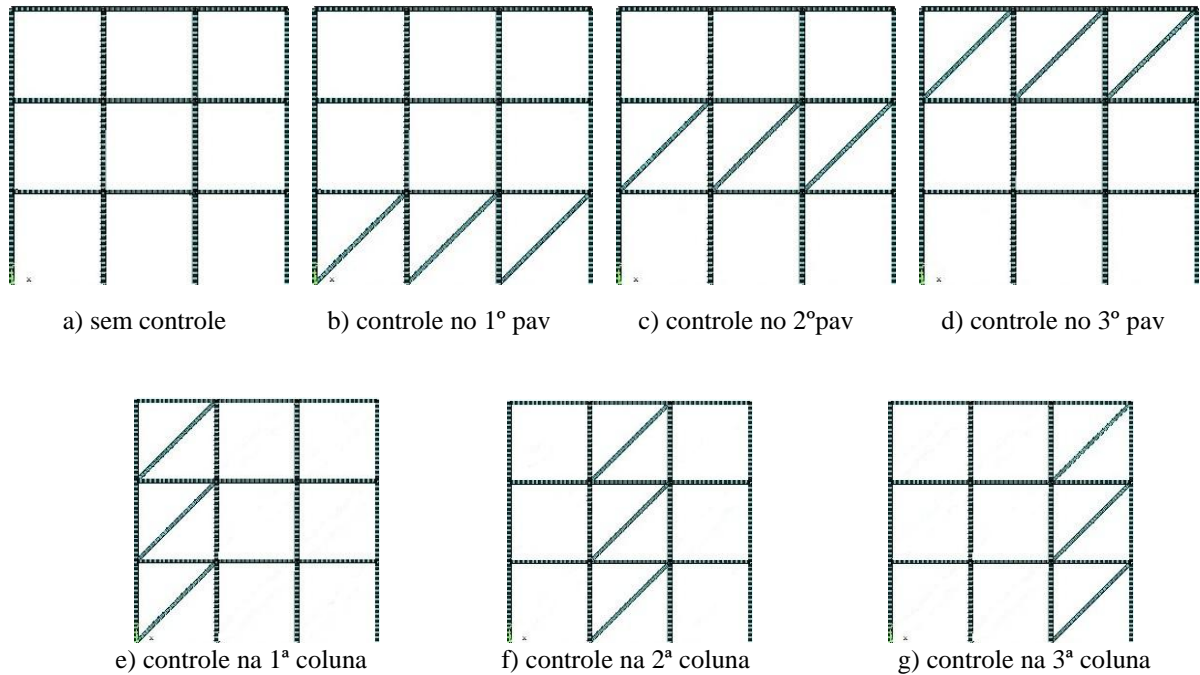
Pórtico com 3x3 pavimentos – caso 1
